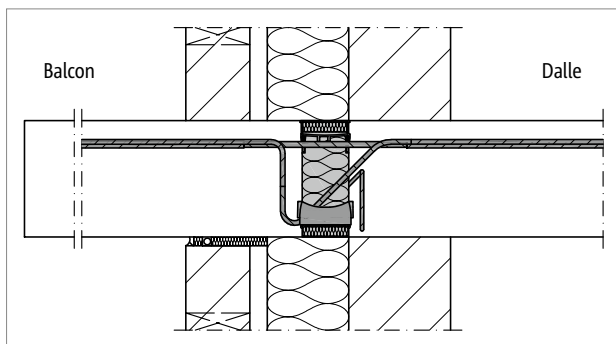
Schöck Isokorb® T Type K-E, K-T : Raccordement avec isolation du noyau
